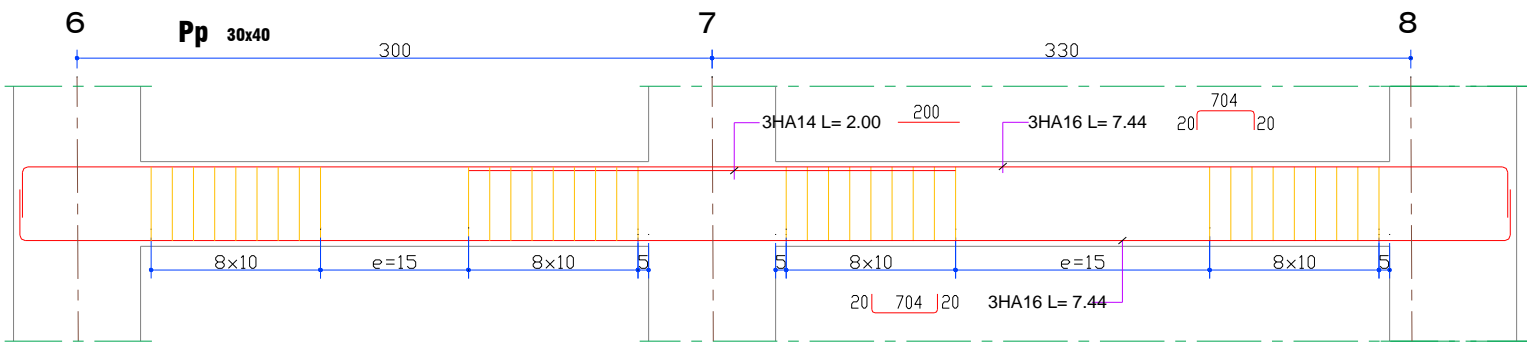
Exemple de ferrailage des poutres principales au niveau de portique 1 de 1^{er} à 3^{ème} et de 12^{ème} et 13^{ème} étage.
